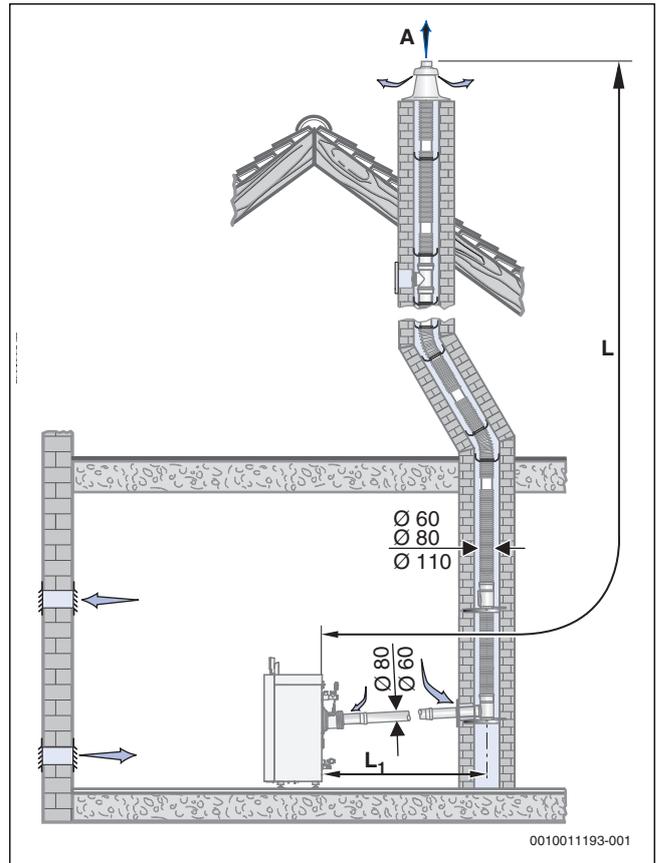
Montagevariante mit dem Bausatz GA + ÜB-Flex
